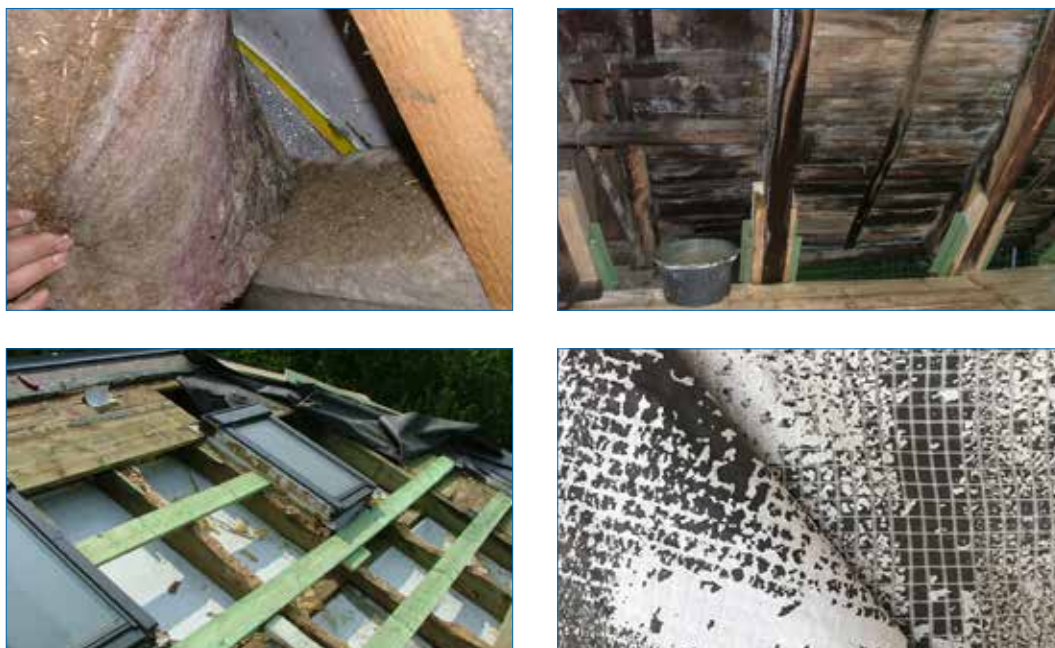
Niewentylowana konstrukcja dachu z całkowicie izolowanymi krokiewiami
